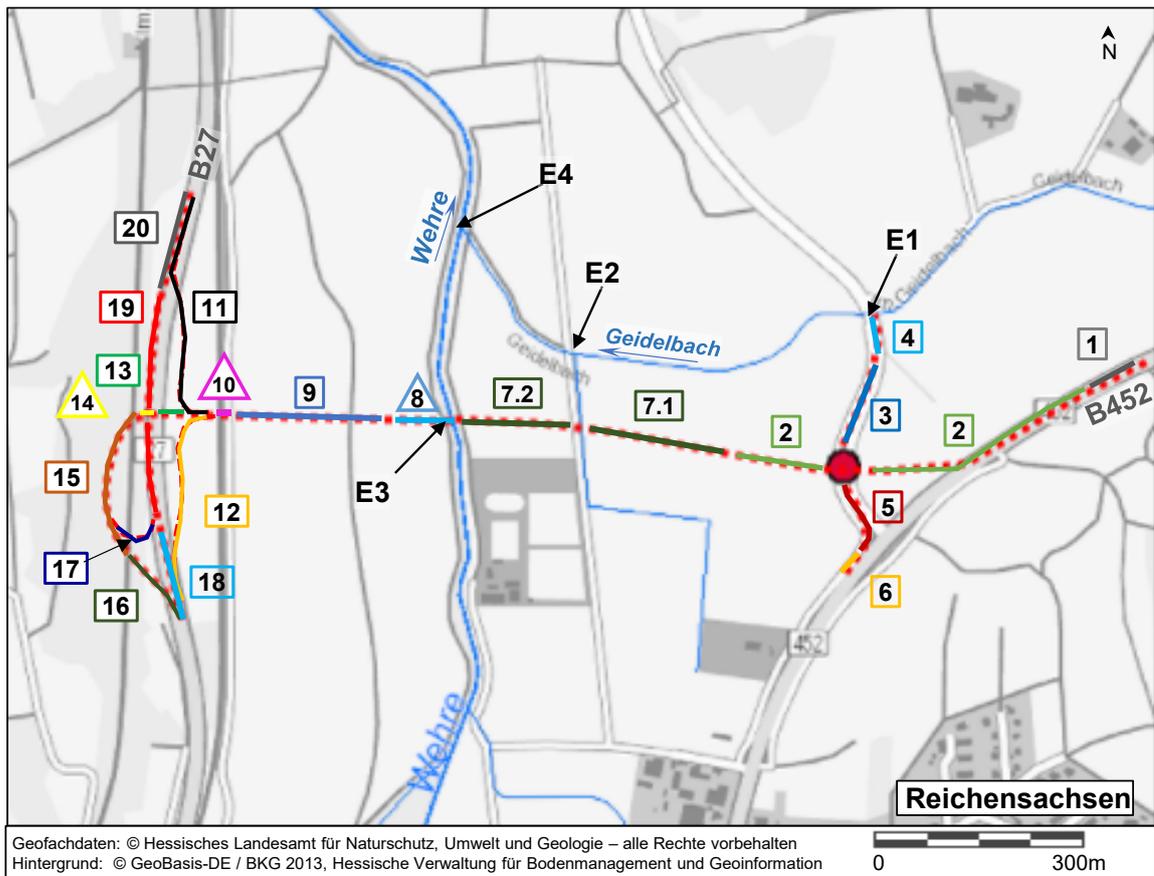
Lage der geplanten Baumaßnahme und der Entwässerungsabschnitte (farbig umrandet; Dreiecke: Entwässerung von Brückenbauwerken), E1 bis E4 = geplante Einleitestellen; Darstellung schematisch, nach: /10/, Kartengrundlage:/3/
